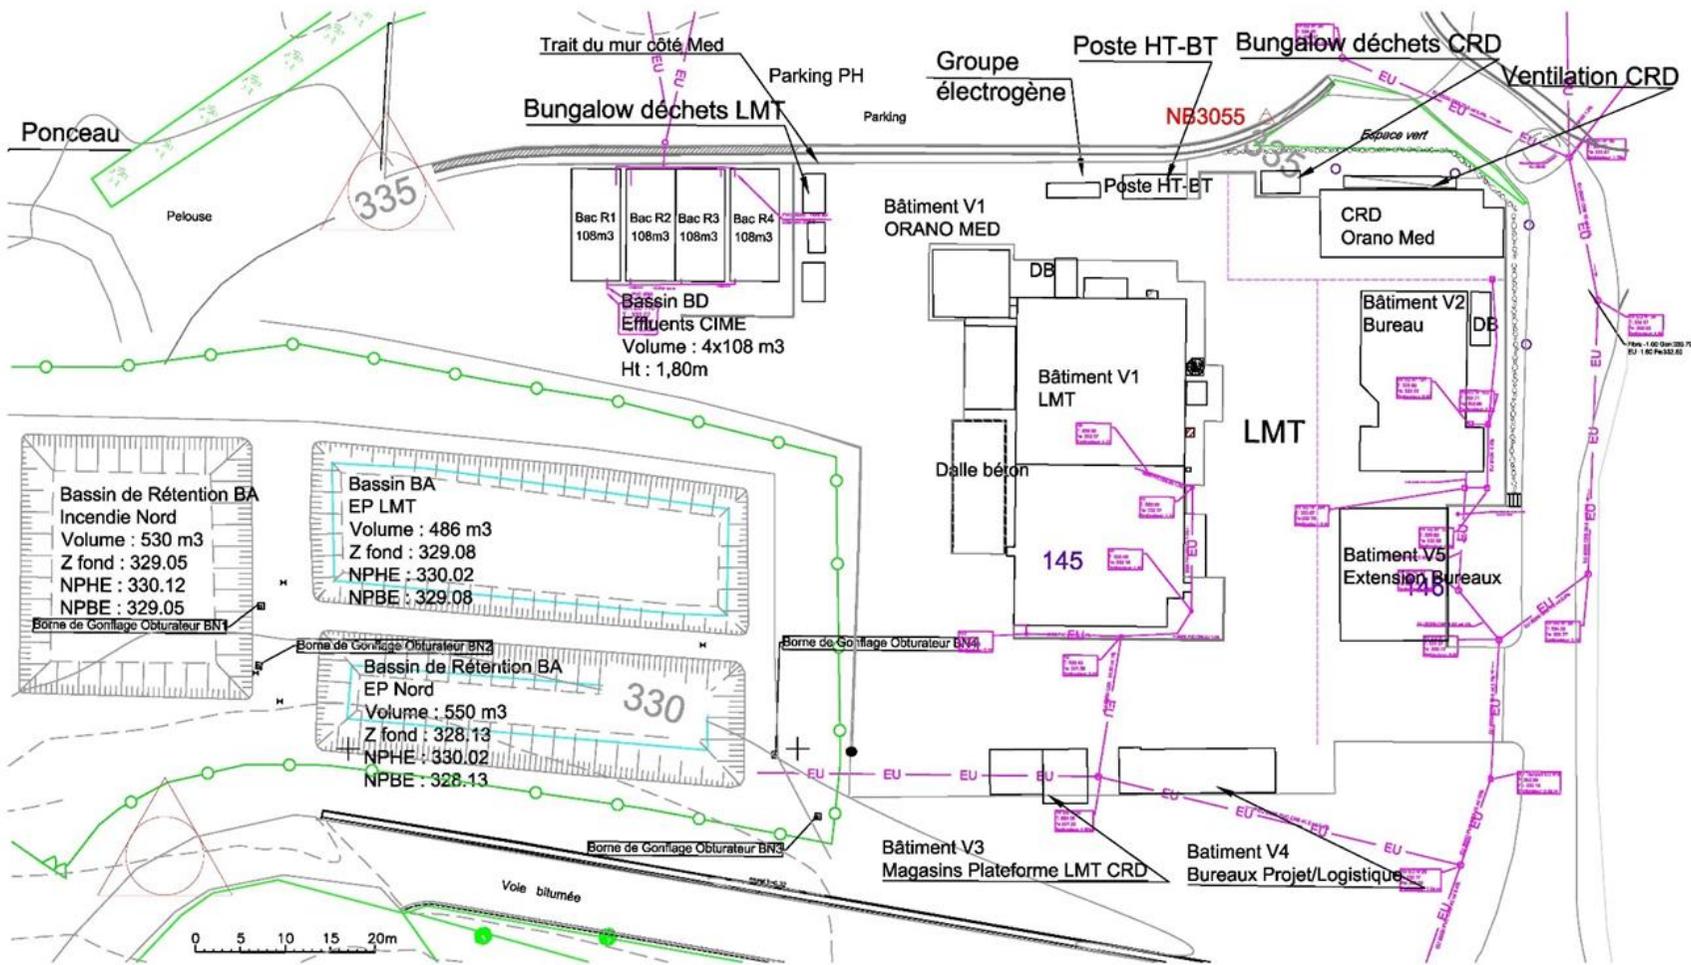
Plan du réseau des eaux usées provenant du LMT
